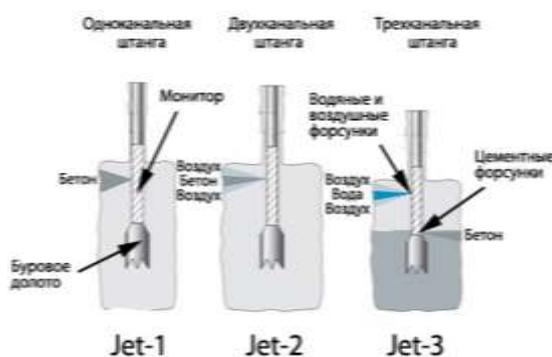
Создание грунтоцемента с помощью систем Jet-1, Jet-2 и Jet-3
